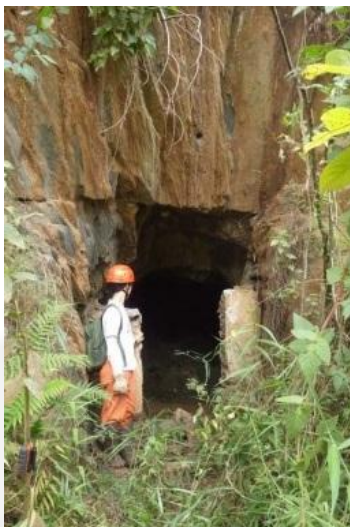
Entrada da galeria em meia encosta com batente de cimento nas laterais. Fonte: EIA, 2014.
